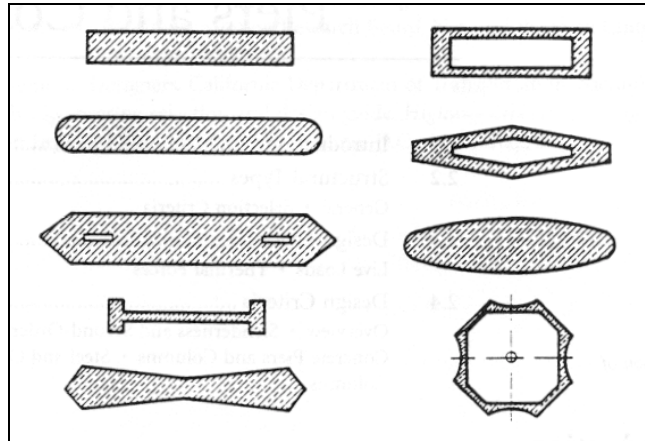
Secciones transversales típicas de pilas para cruces de ríos o canales.
